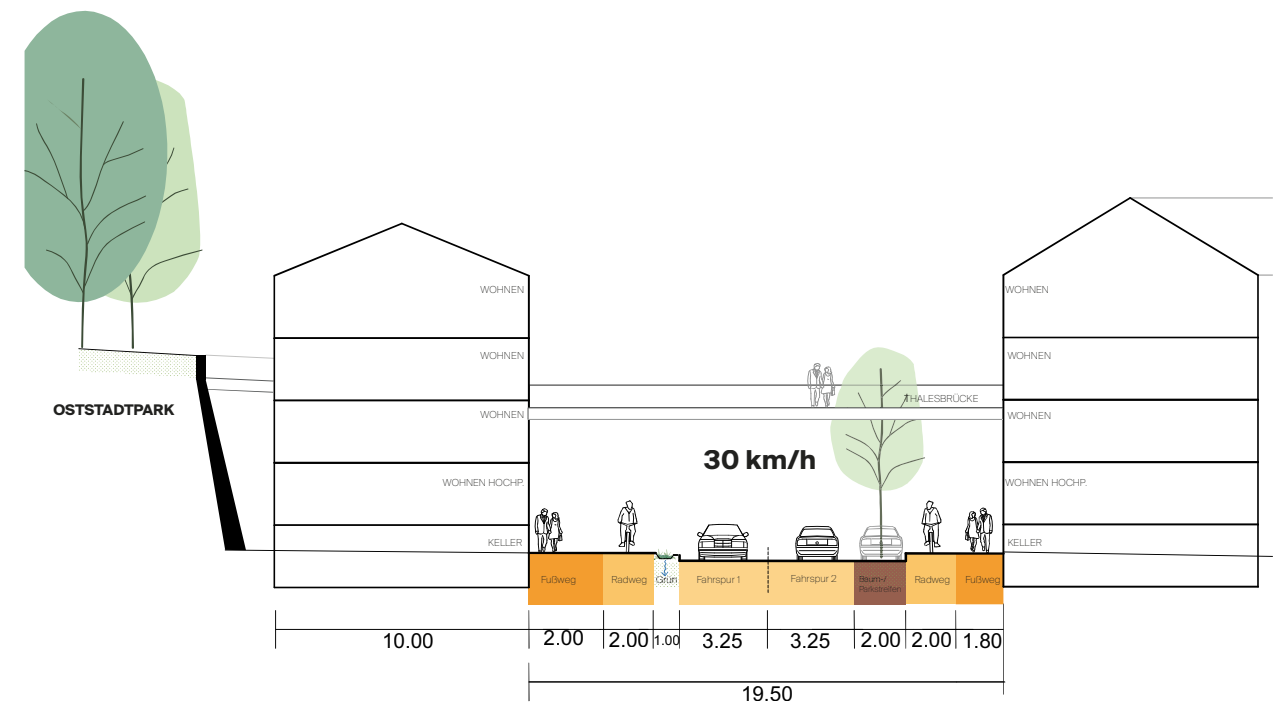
Schnitt „Oststadt-Park/Lindenstr.“ - Rahmenplan
